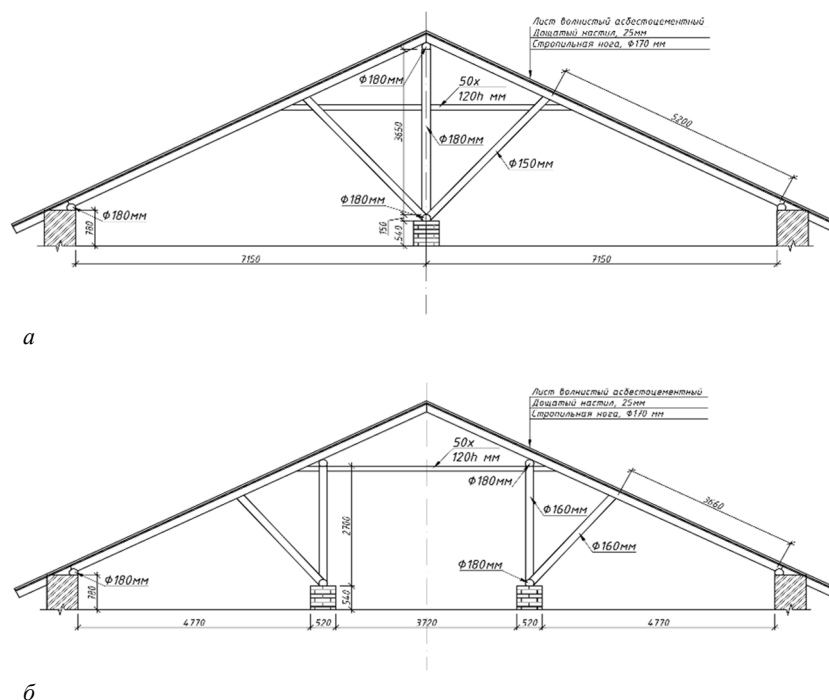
Сечение 1-1(3-3) стропильной конструкции (а). Сечение 2-2 стропильной конструкции (б)
